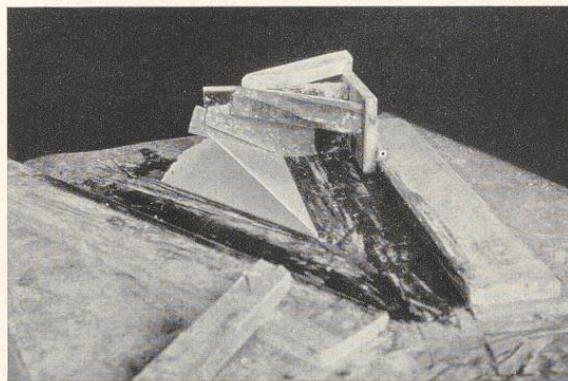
Verjüngter Zug einer Sternspitze mit halber Schablone
